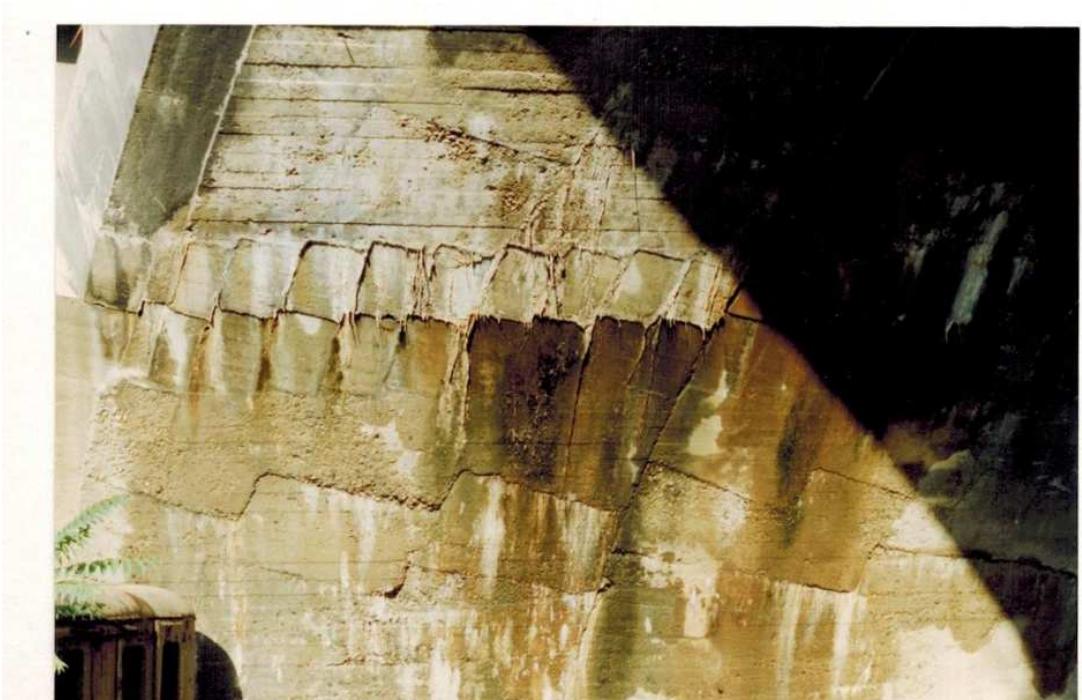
Stav konstrukce v roce 2015. Doplněná zajišťovací podpůrná konstrukce a pokračující silná degradace. Výrazné zhoršení stavu.
